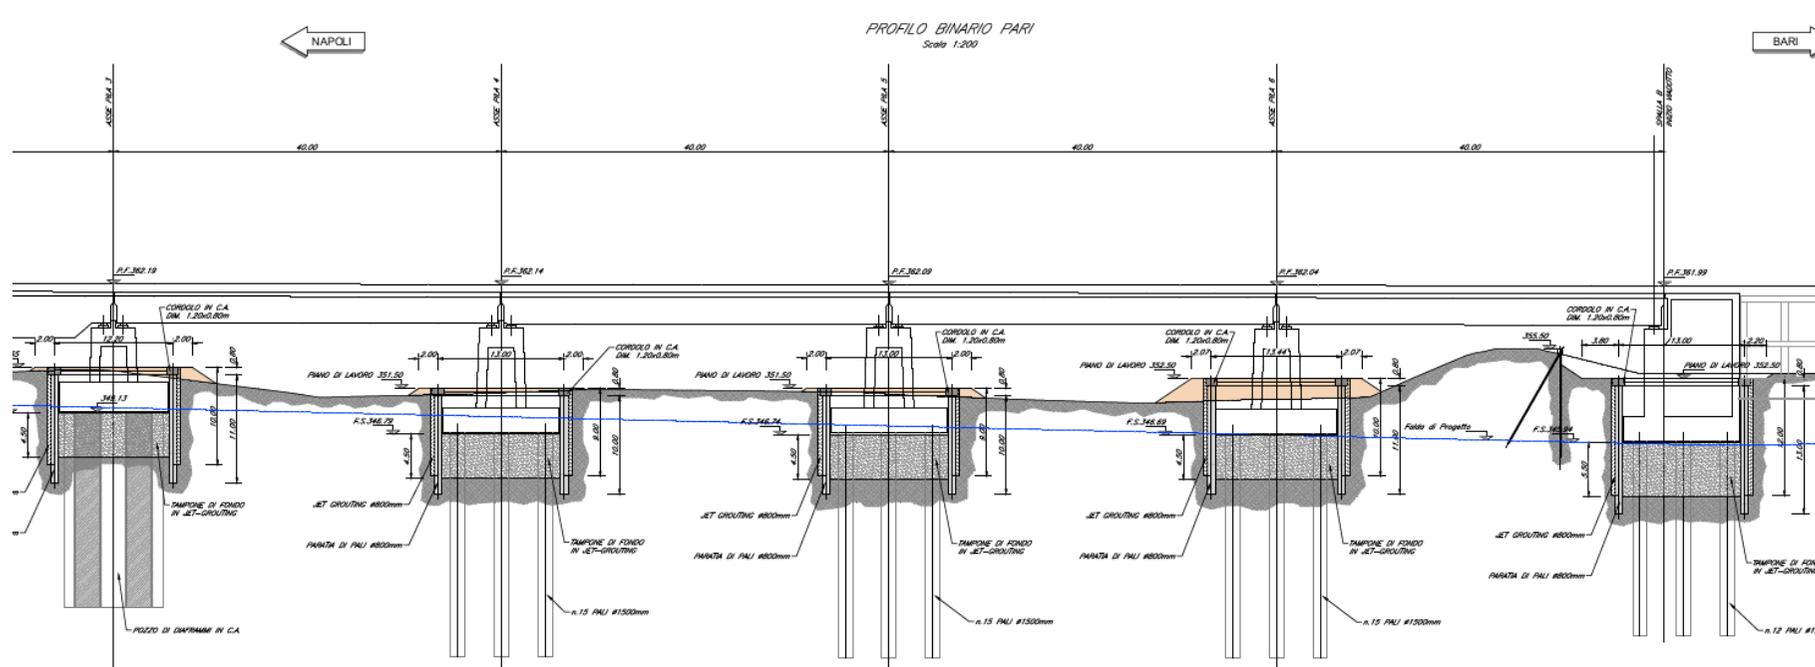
Pila 3, 4, 5, 6, Spalla B – Opere provvisionali - Profilo longitudinale
